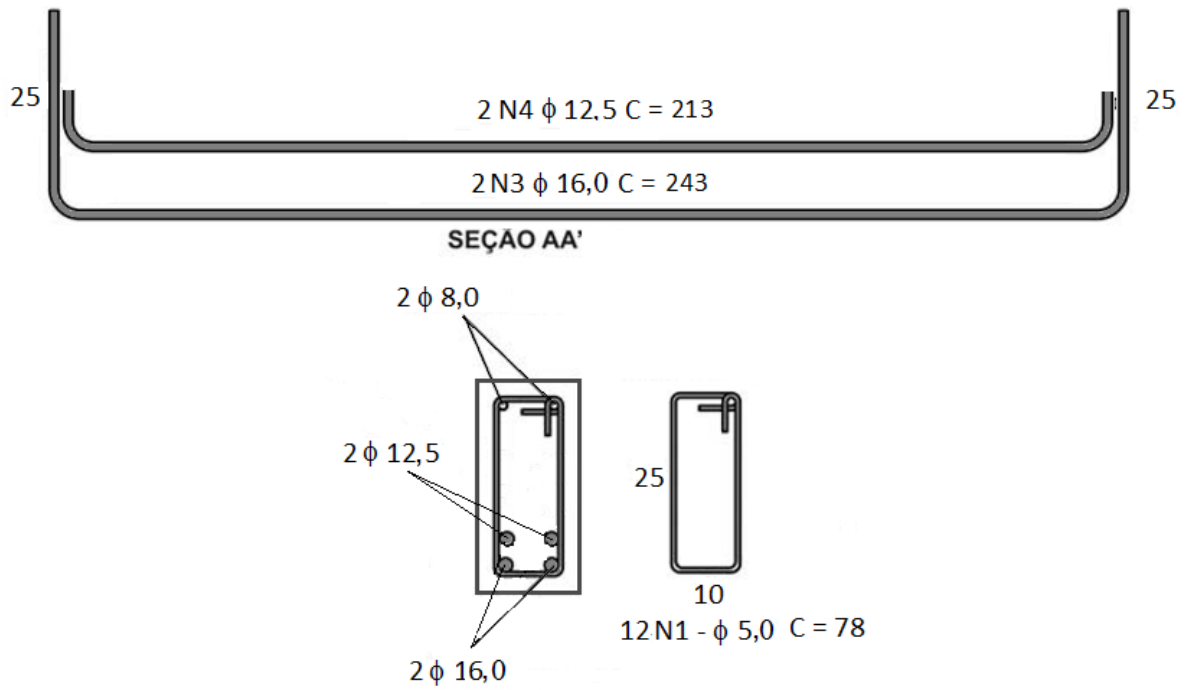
Armaduras das vigas do Tipo 2 (dimensões em centímetros, exceto diâmetros que estão em milímetros).
